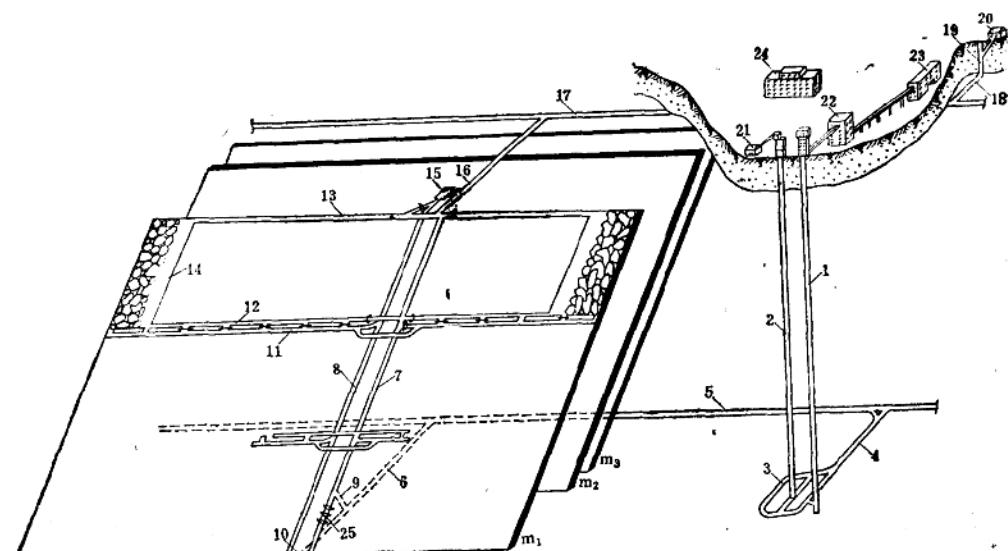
矿井巷道系统及地面总平面布置示意图
